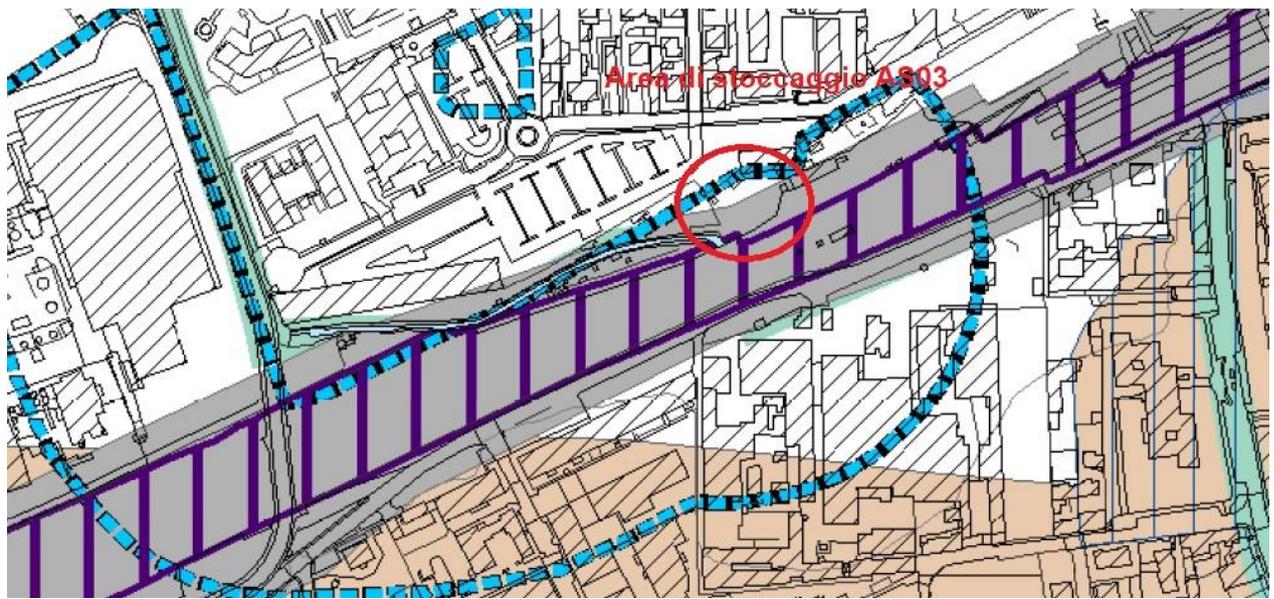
Cantiere di stoccaggio - AS03 [PD 2017]
